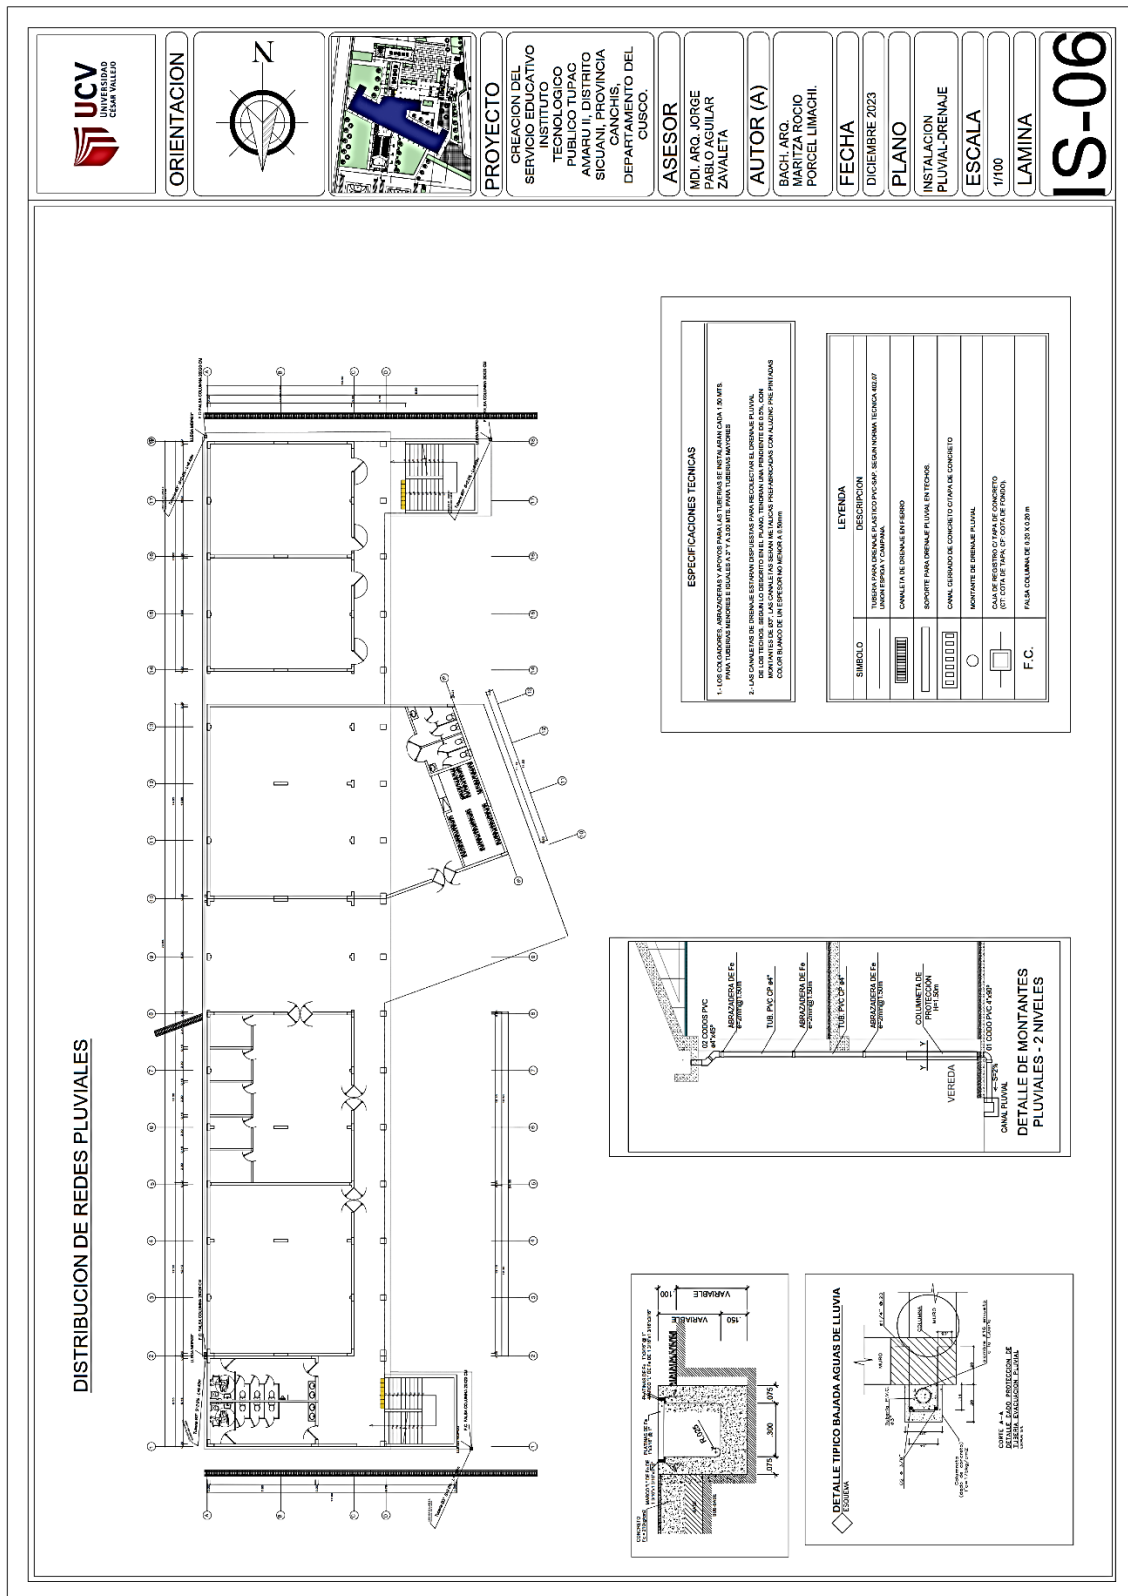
Plano de instalaciones sanitarias drenaje pluvial - alcantarillado
